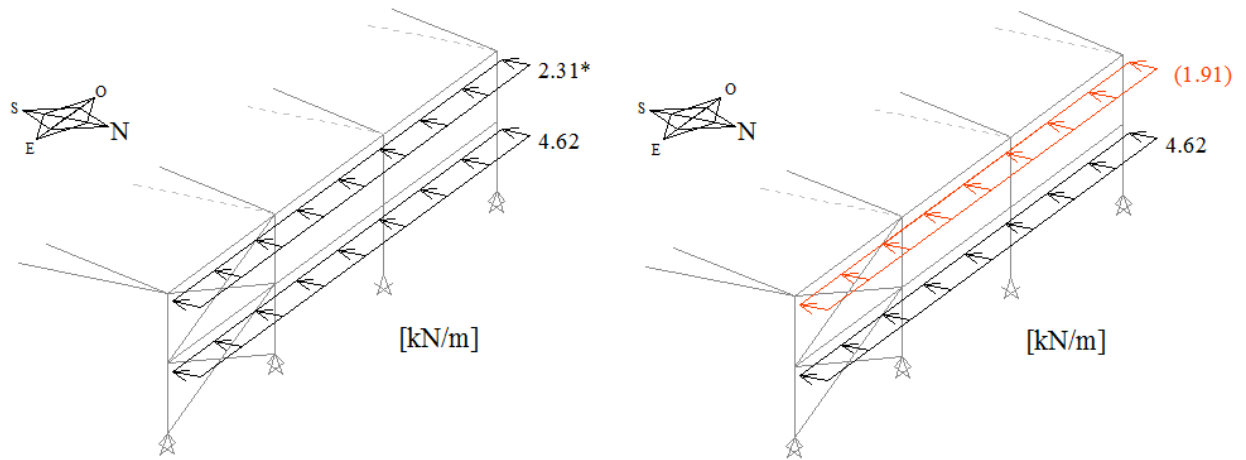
Vento W1 na fachada orientada a Norte na situação 2 (EC1.1.4)
